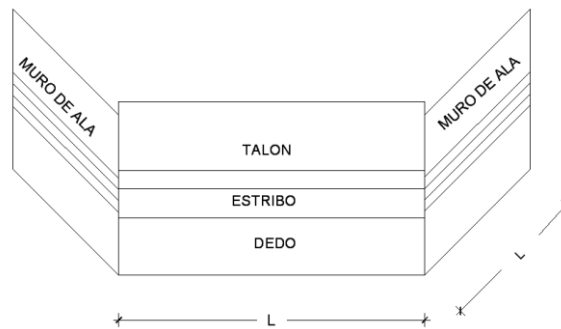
56 Esquema en planta Estribo y Muro de ala
